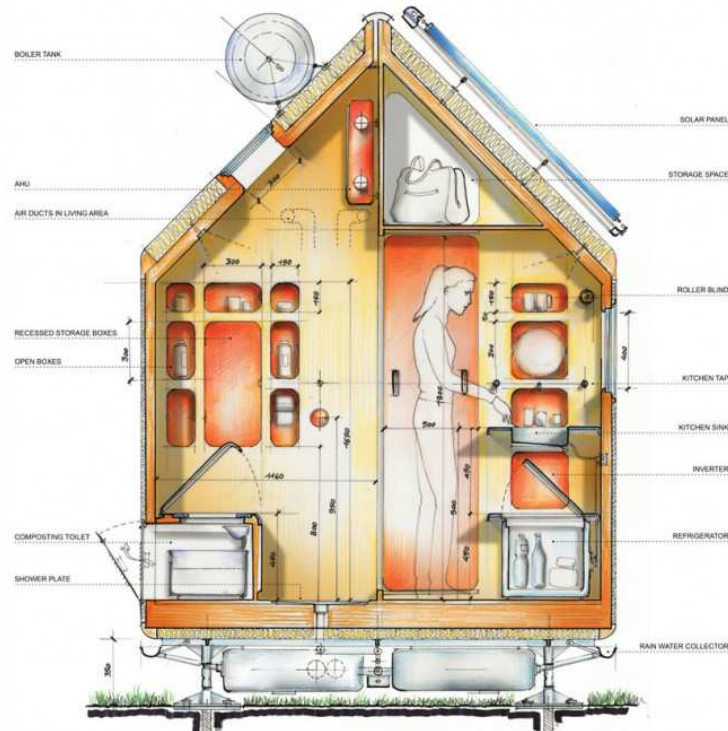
Renzo Piano. *Corte 1 - Cozinha, banheiro e ático.* Fonte: Renzo Piano.
